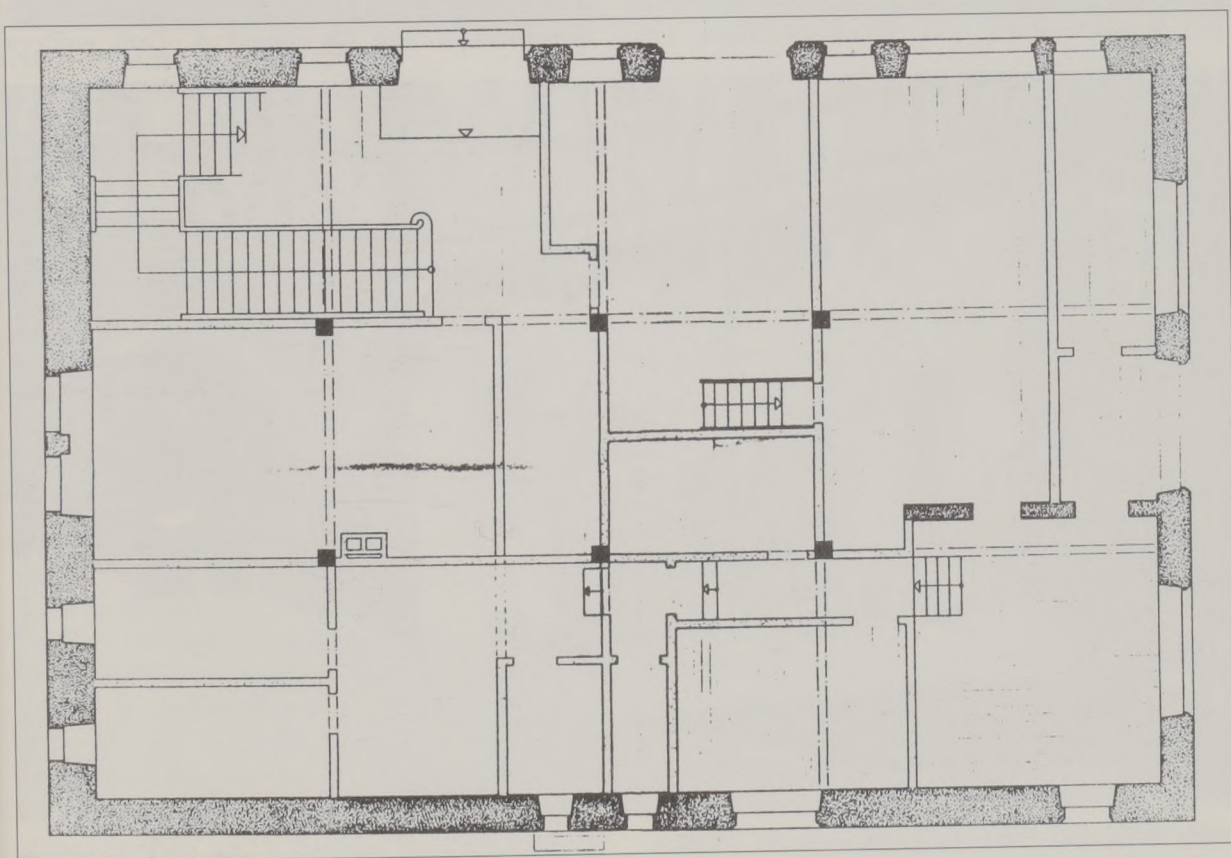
Erdgeschoß-Grundriß, Bauaufnahme von Reiner Serve, 1953 (Institut für Baugeschichte der Universität Stuttgart).
